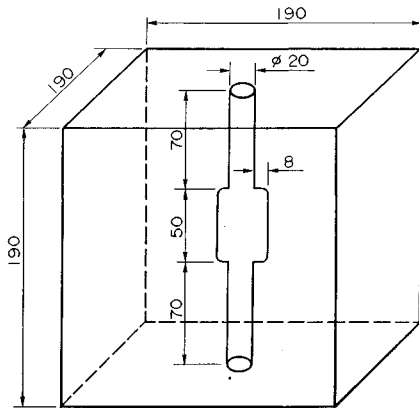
供試体の形状、寸法およびスロットの位置 (単位: mm)
